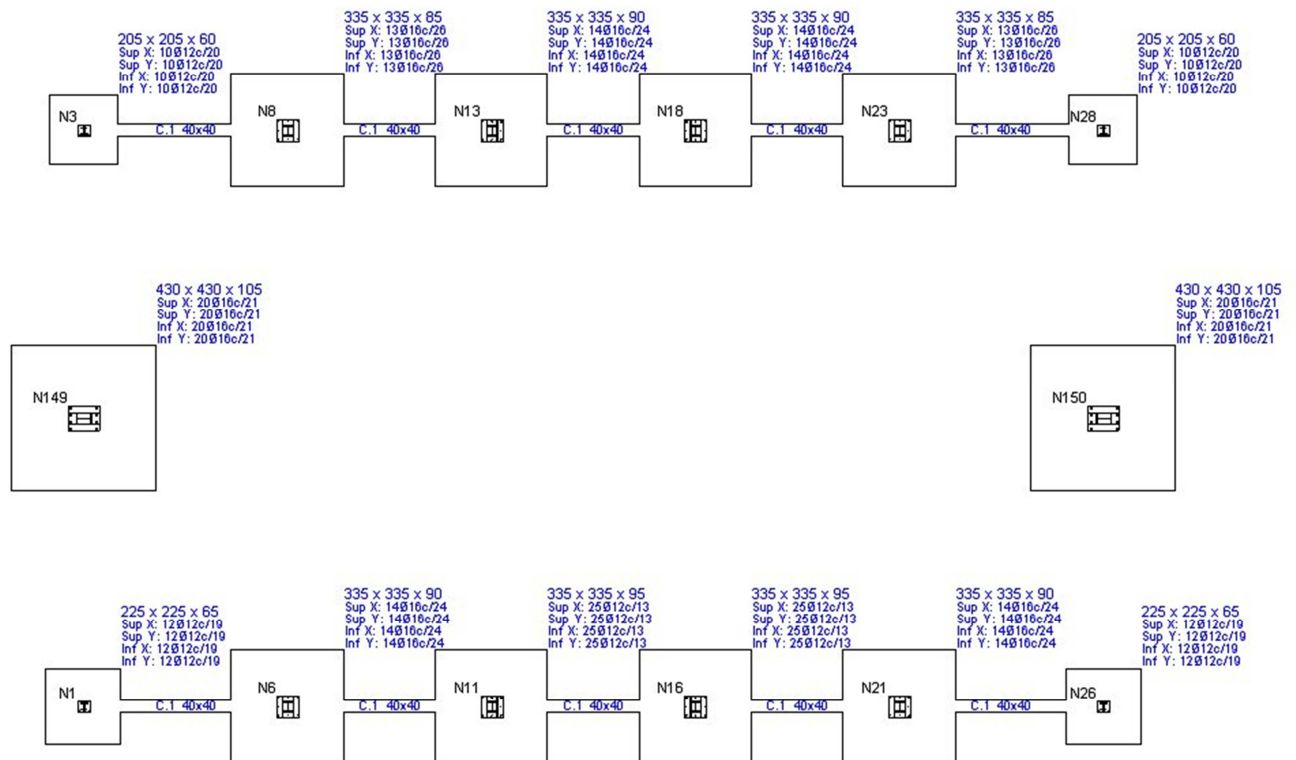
Cimentación Pórtico de celosía con tirantes en fachada
